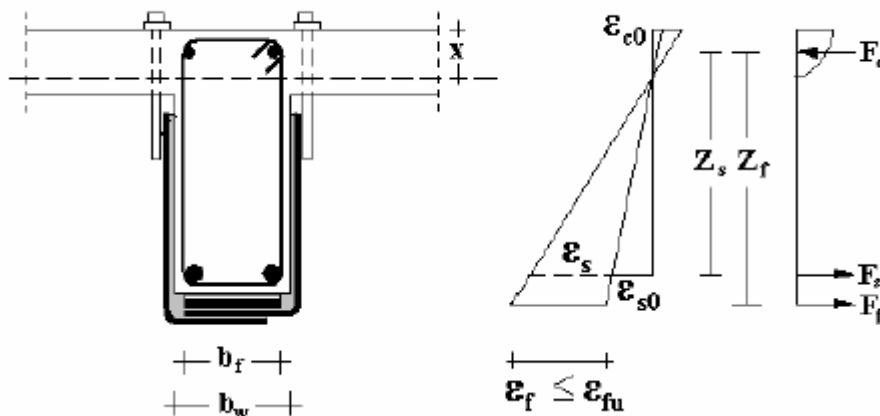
Distribuição de tensões numa seção transversal de concreto armado reforçado com CFC (Neubauer e Rostásy, 1996).
